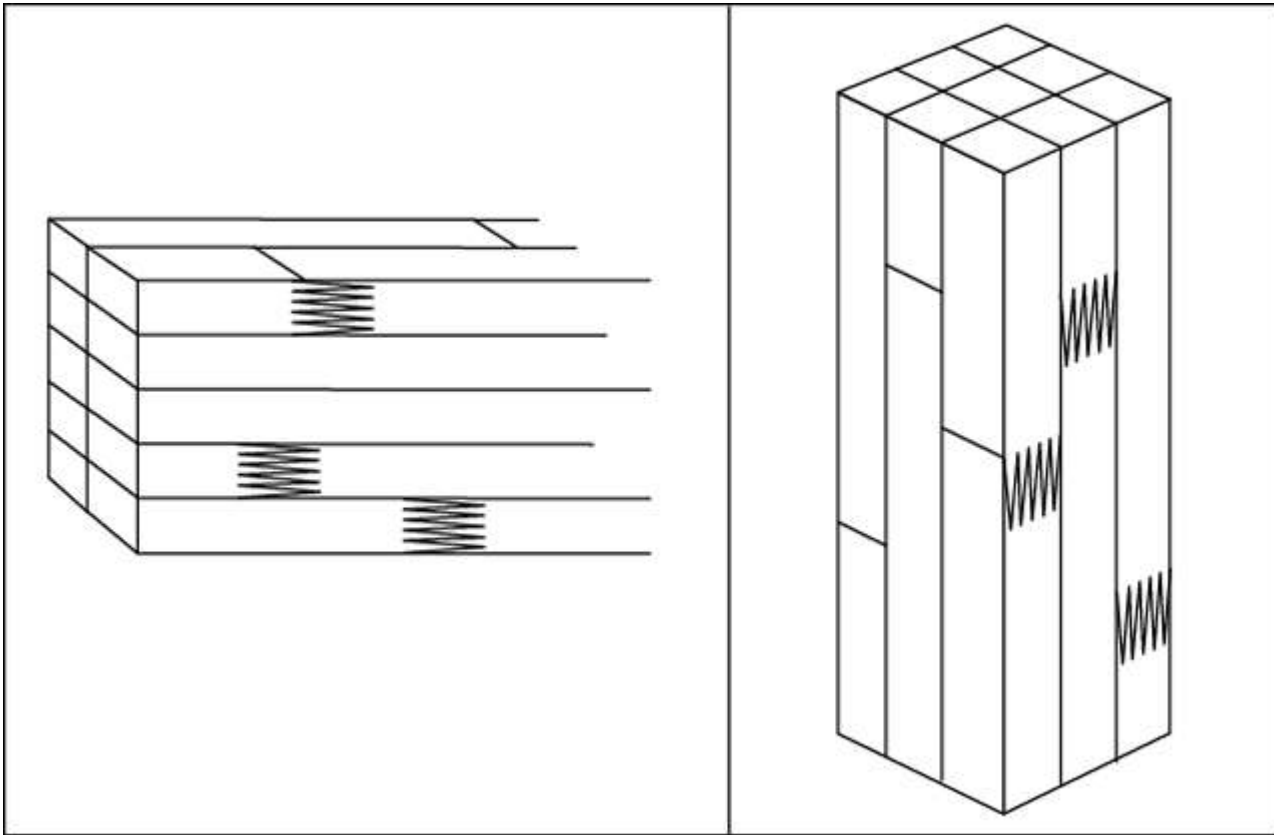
Exemples de poutre et de poteau fabriqués au moyen de courtes lamelles assemblées par entures multiples et collées sur la face
